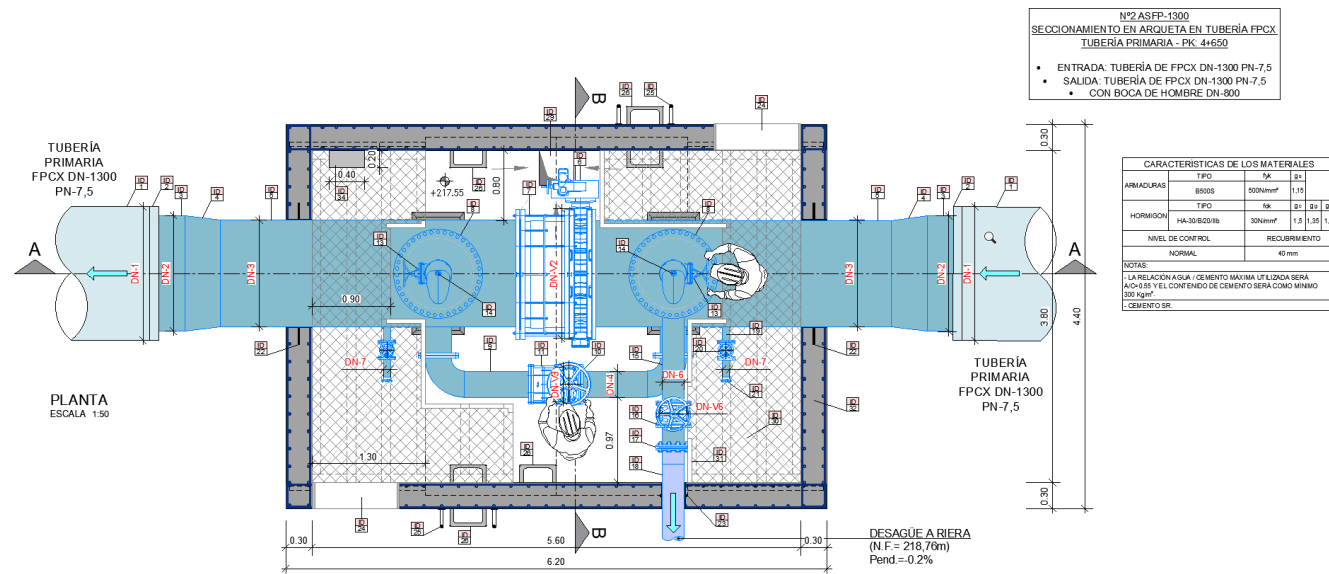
Seccionamiento nº 2 de tipo ASFP. Tubería primaria PQ 4+650.
